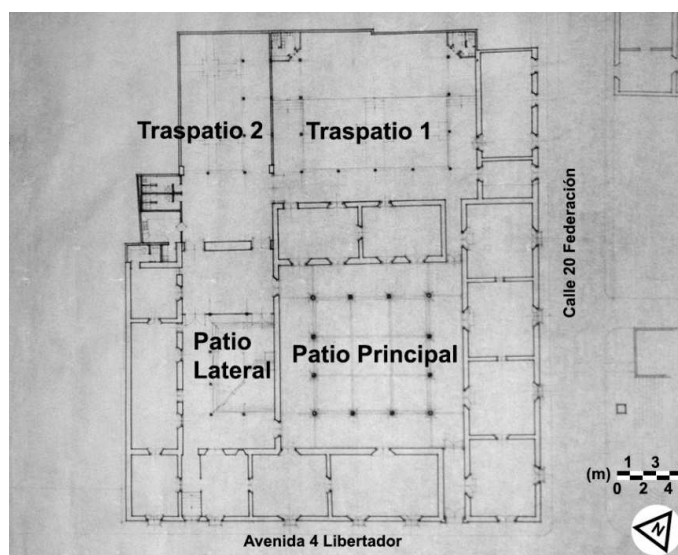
Planta de la casa Paredes. Fuente: Imagen a partir de foto de un plano de proyecto.
